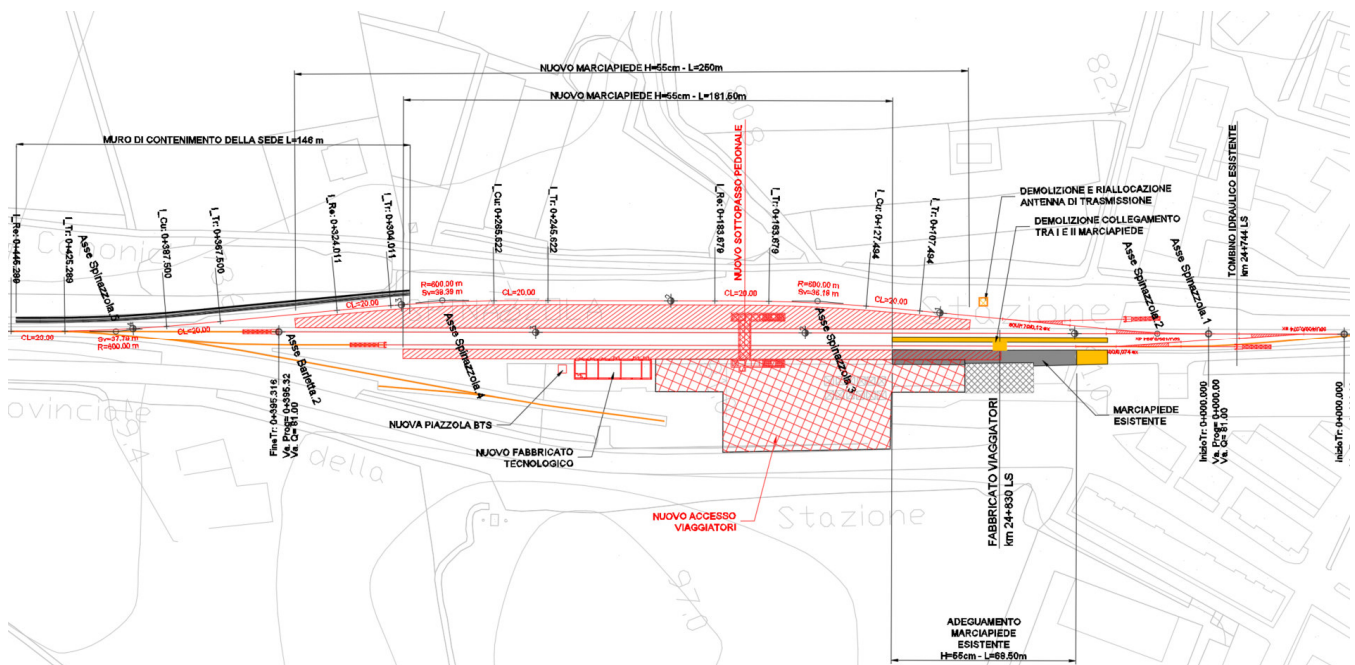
Planimetria di Progetto - Modifica al PRG di Canosa di Puglia
